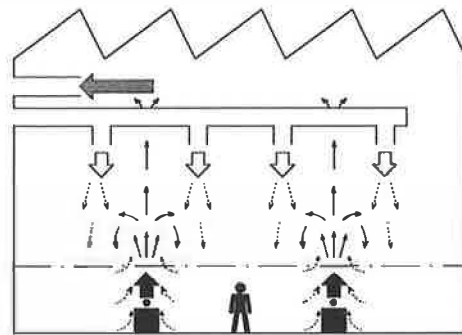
Strömungsbild bei hallenfüllender Mischströmung mit Luftzufuhr unter dem Hallendach
